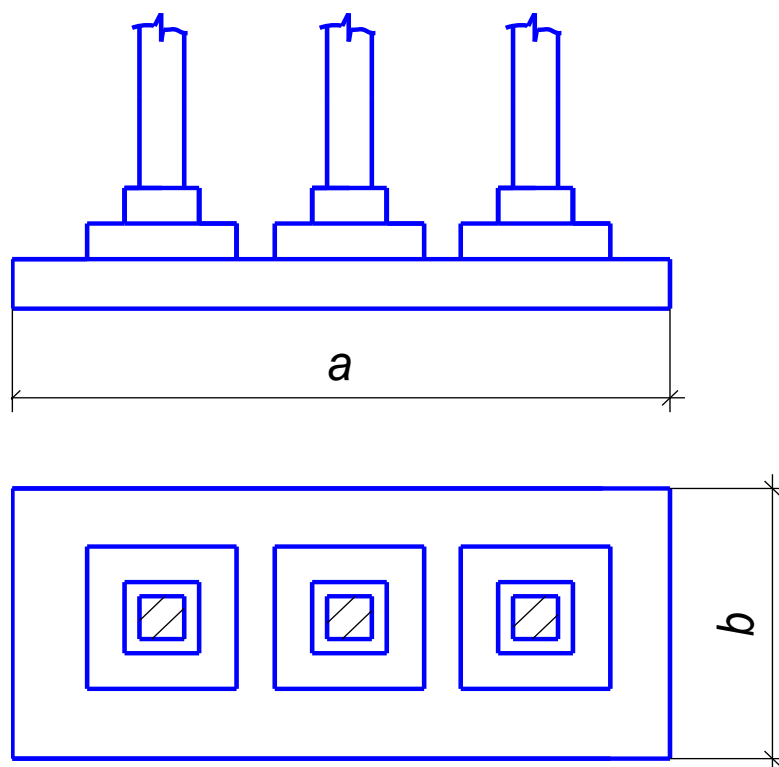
Схема ленточного фундамента под стоечную опору путепровода.
